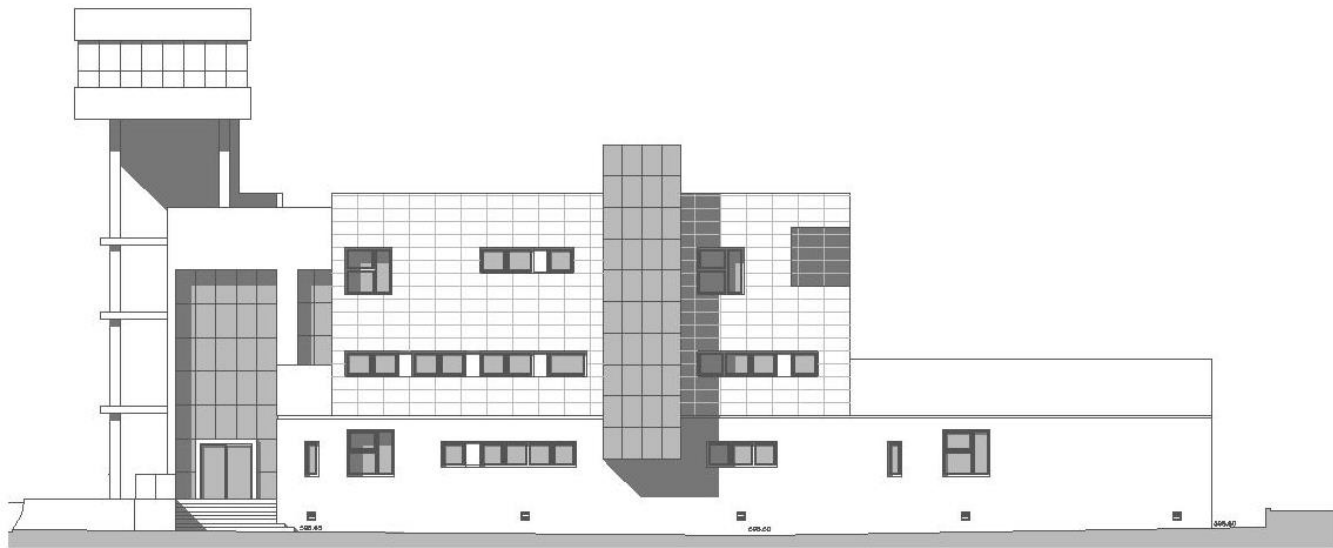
Alzado posterior. Fuente: Proyecto técnico de ejecución.
